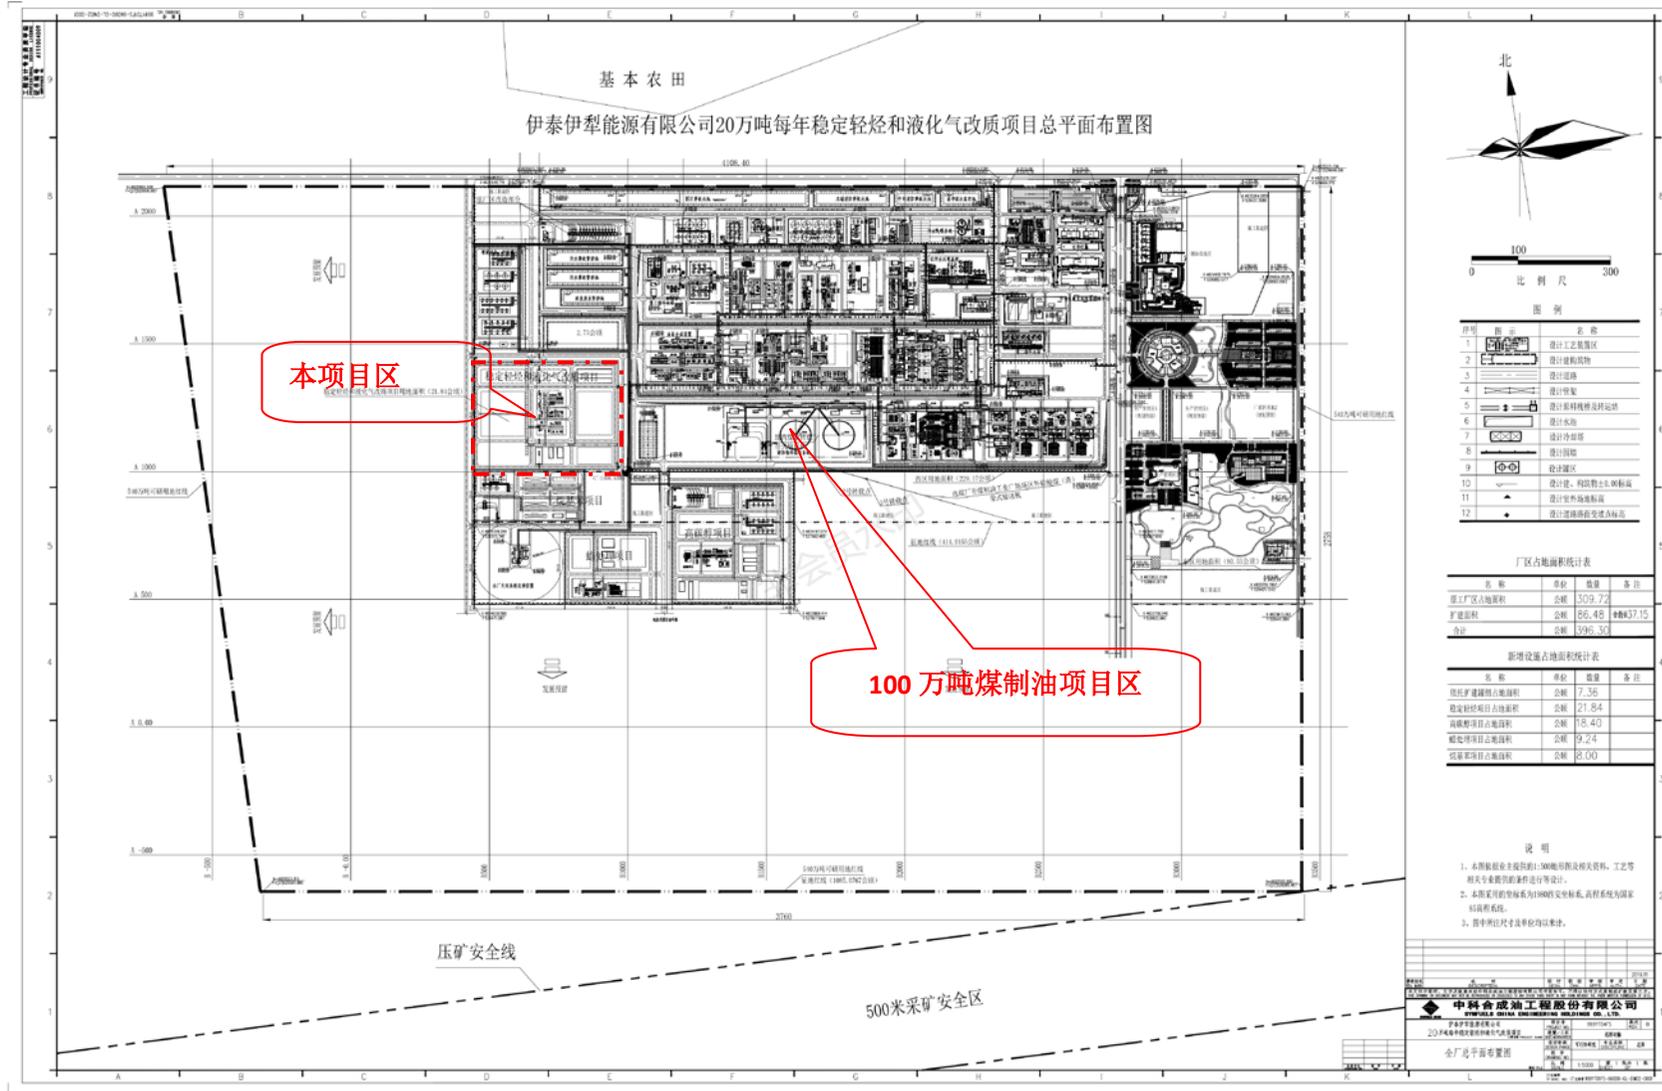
稳定轻烃和液化气改质项目总平面布置示意图
